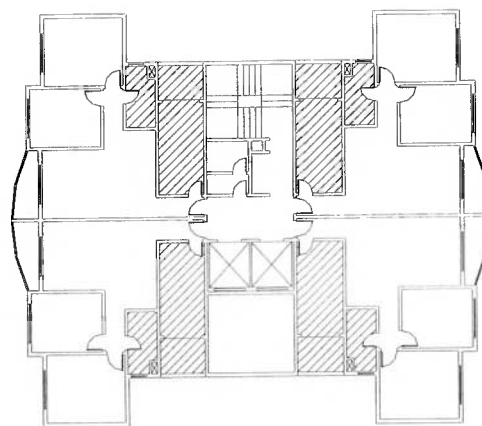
Planta do pavimento-tipo indicando, os ambientes de revestimento interno executada (Obra SP 30).
